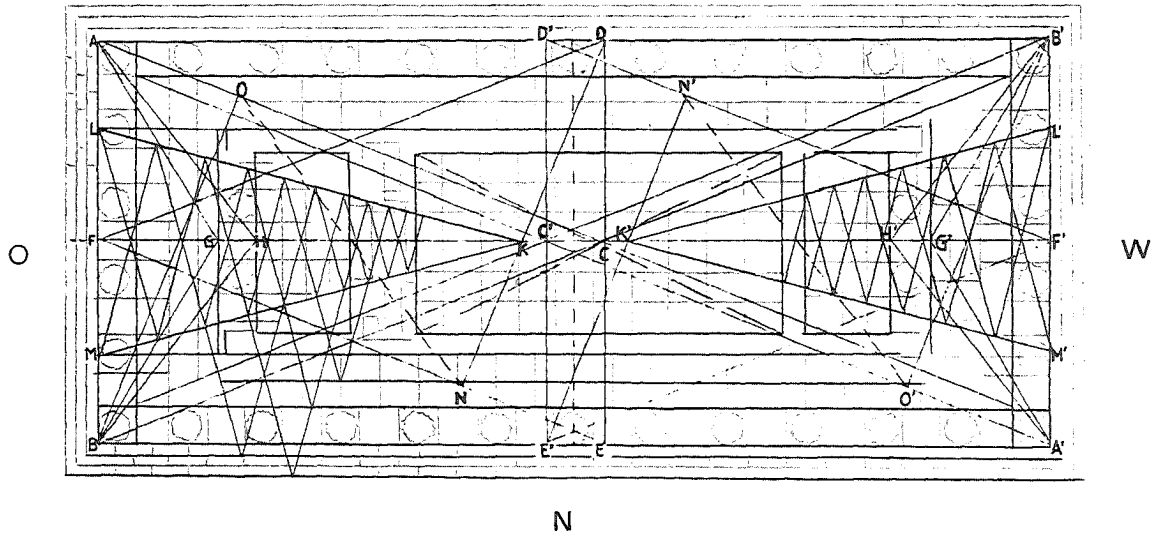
Grundrißkonstruktion des Concorde Tempels
